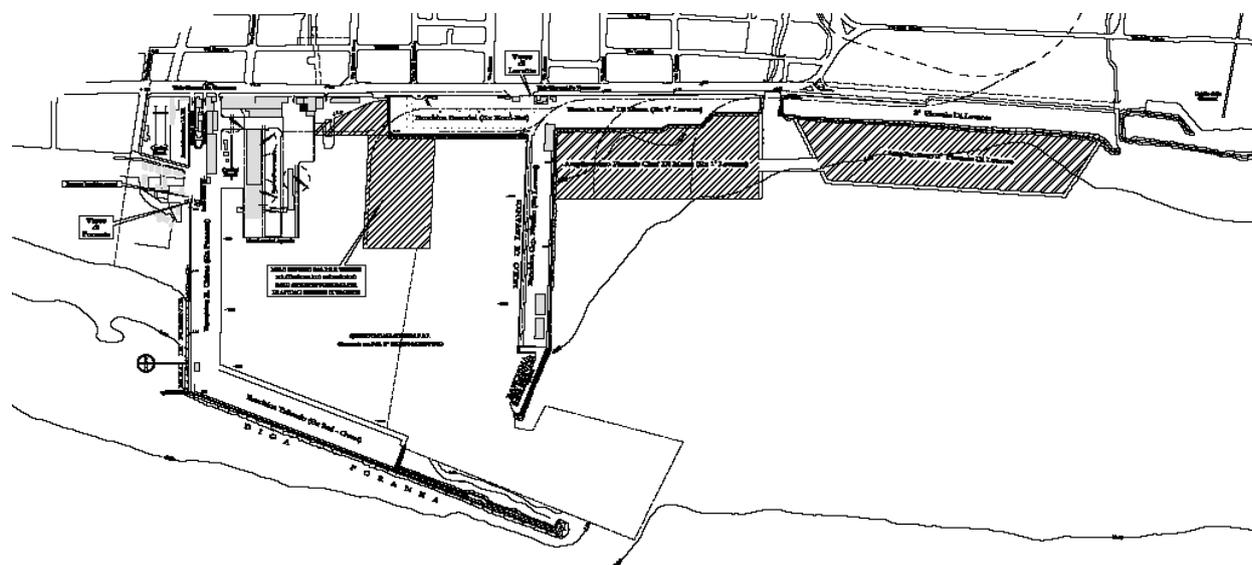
Planimetria del PRP del 1981, vigente (fonte: Archivio AdSP)
